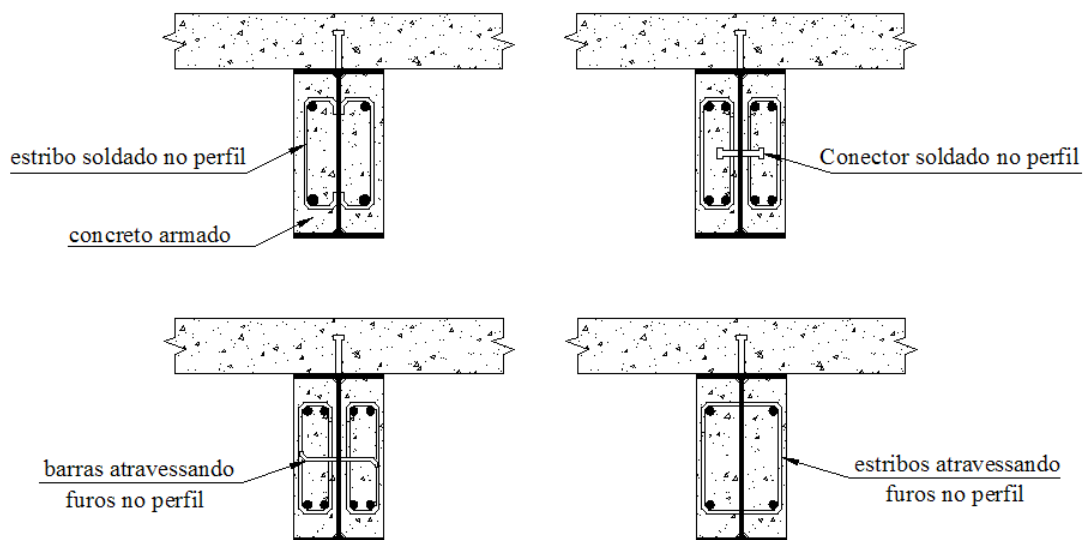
Métodos construtivos para a interação do concreto entre as mesas e o perfil metálico.
